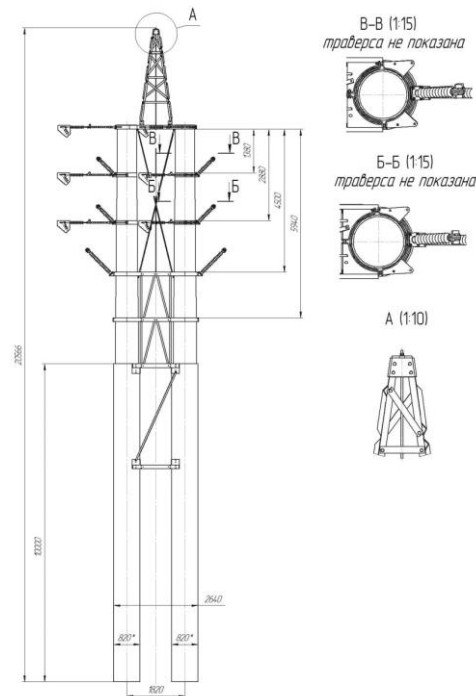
Габаритный чертеж двухцепной анкерной опоры 110 кВ.
